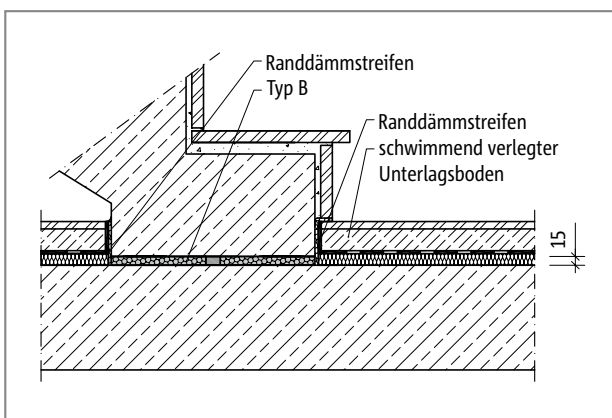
Schöck Tronsole® Typ B: Brandschutzausführung
